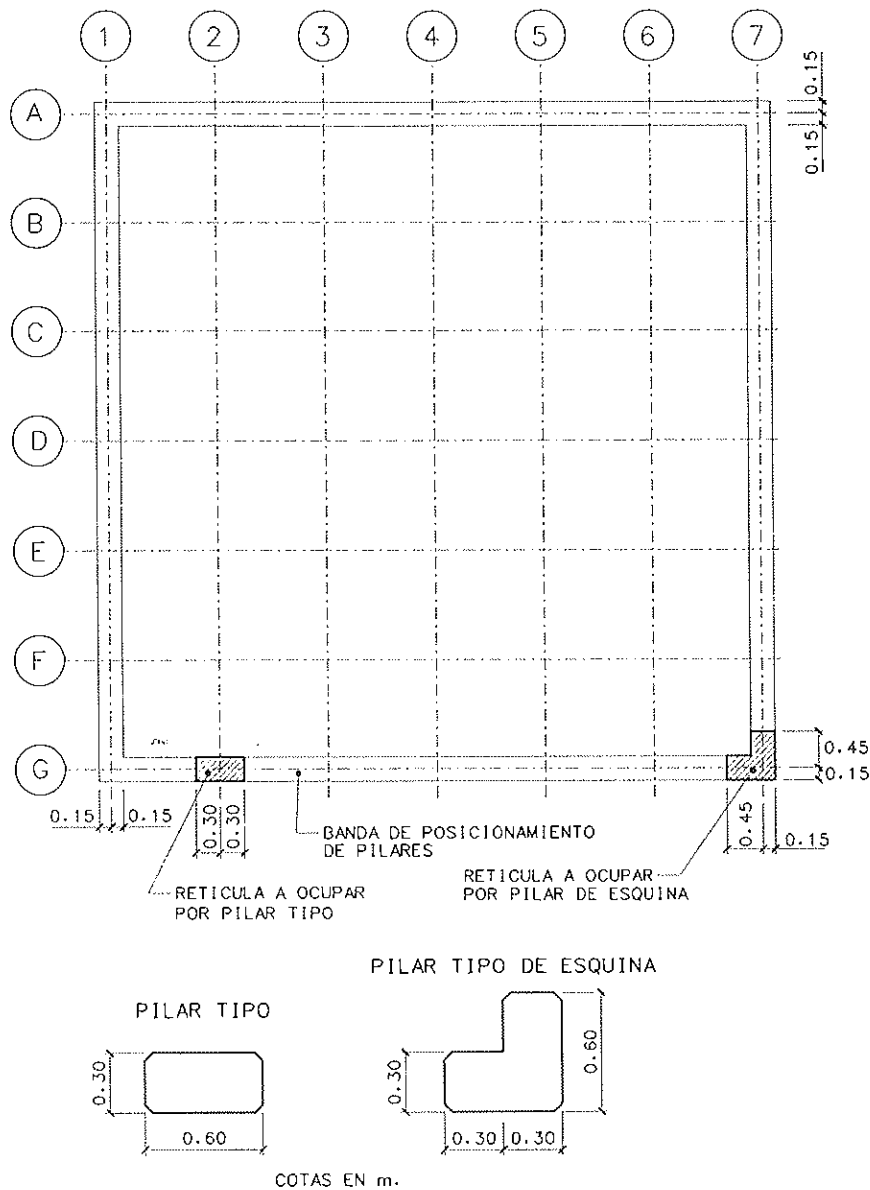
Posicionamiento de la estructura vertical, en Planta.
